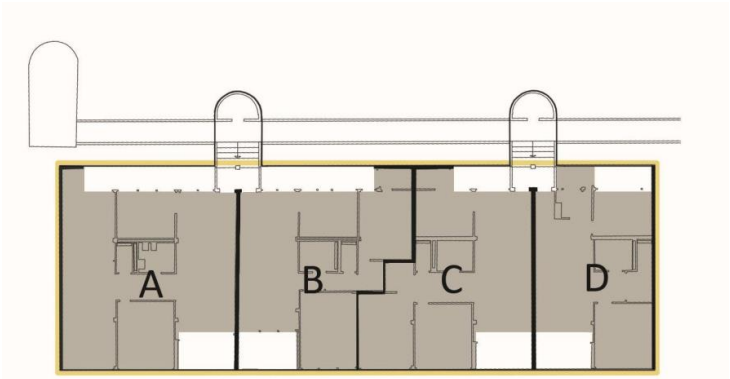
Pianta tipologica di alloggi, con indicazione del perimetro da isolare e delle logge da chiudere
